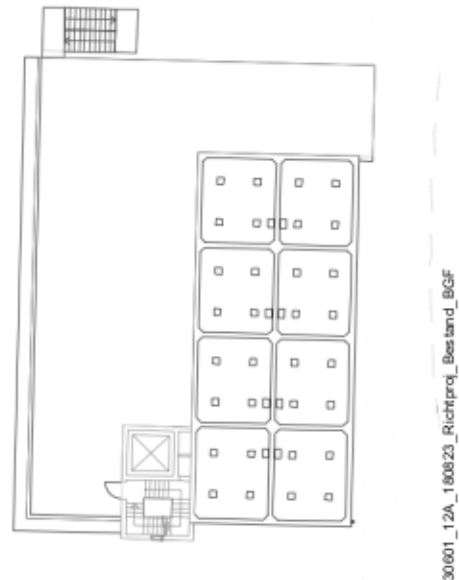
Ausschnitt Richtprojekt für Zuckersilo mit aussenliegender Erschliessungsanlage im Norden
